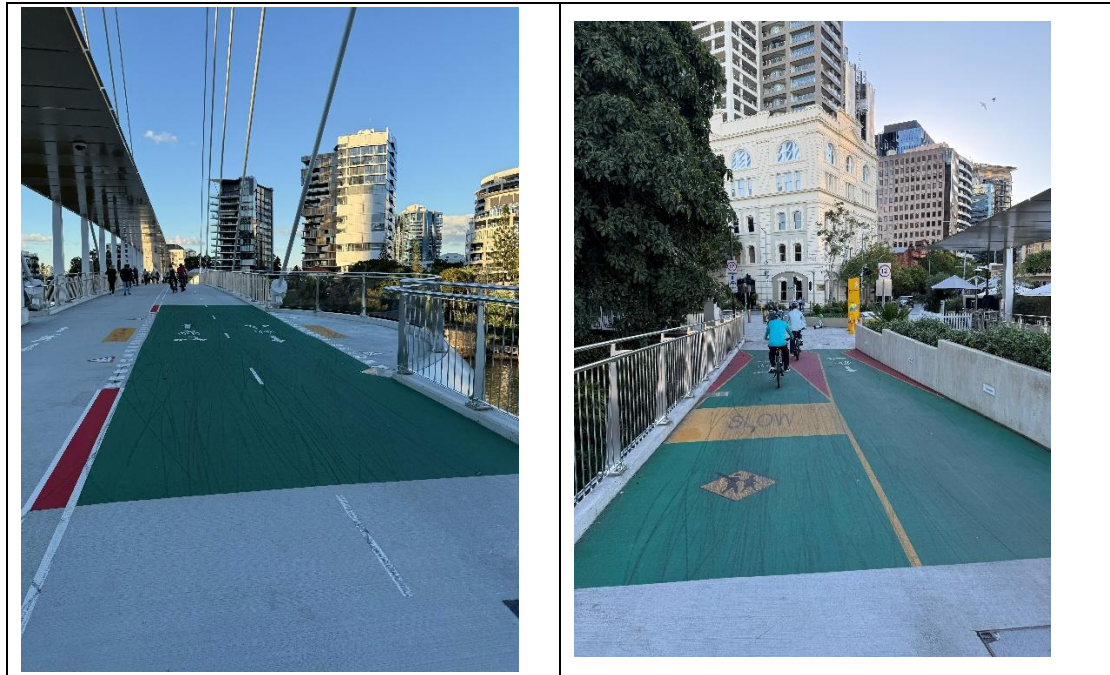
袋鼠角大橋（Kangaroo Point Bridge）實景
